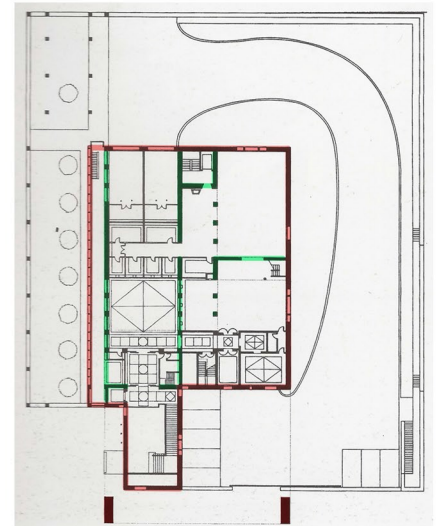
Planta del edificio modificada por el alumno, se muestra el perímetro y la estructura de muros
